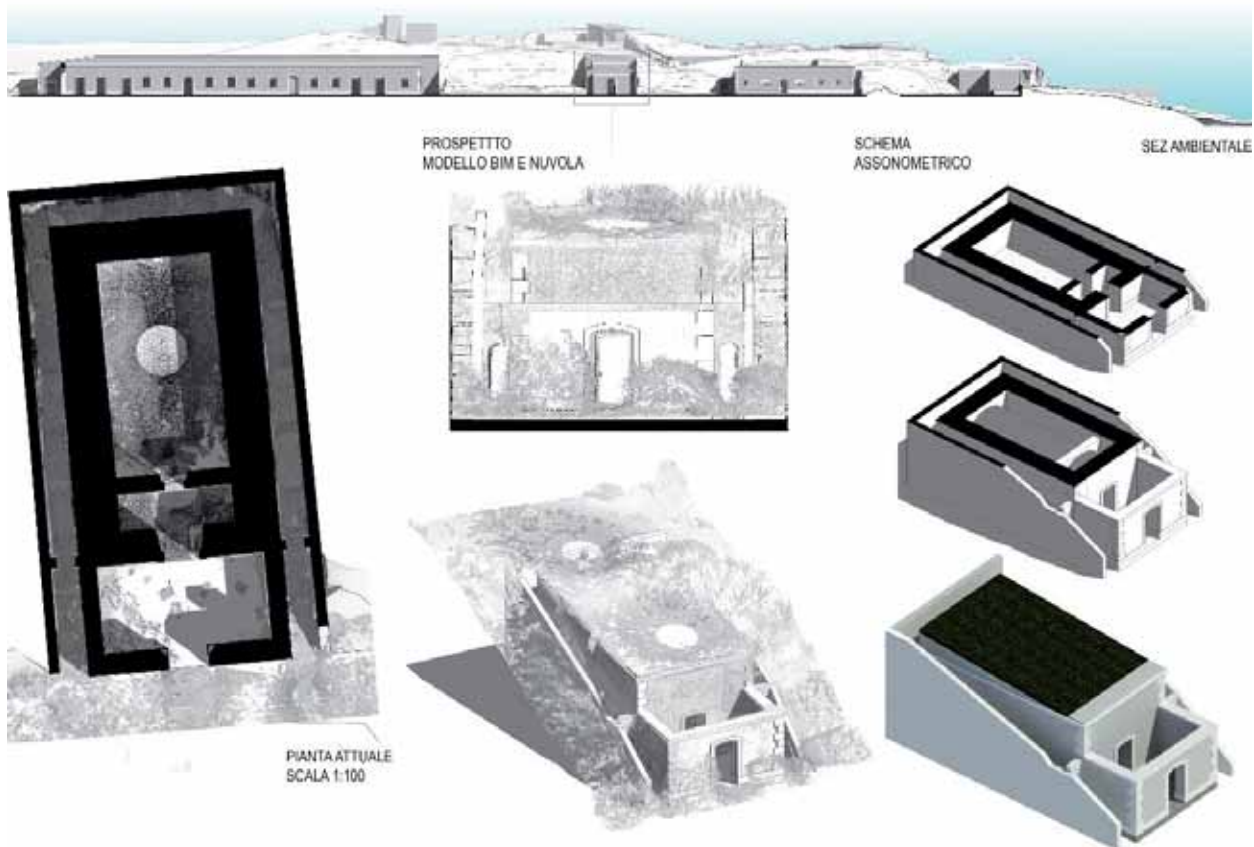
Scheda di analisi 2. Ex Deposito munizioni: pianta, prospetto e spaccati assonometrici
